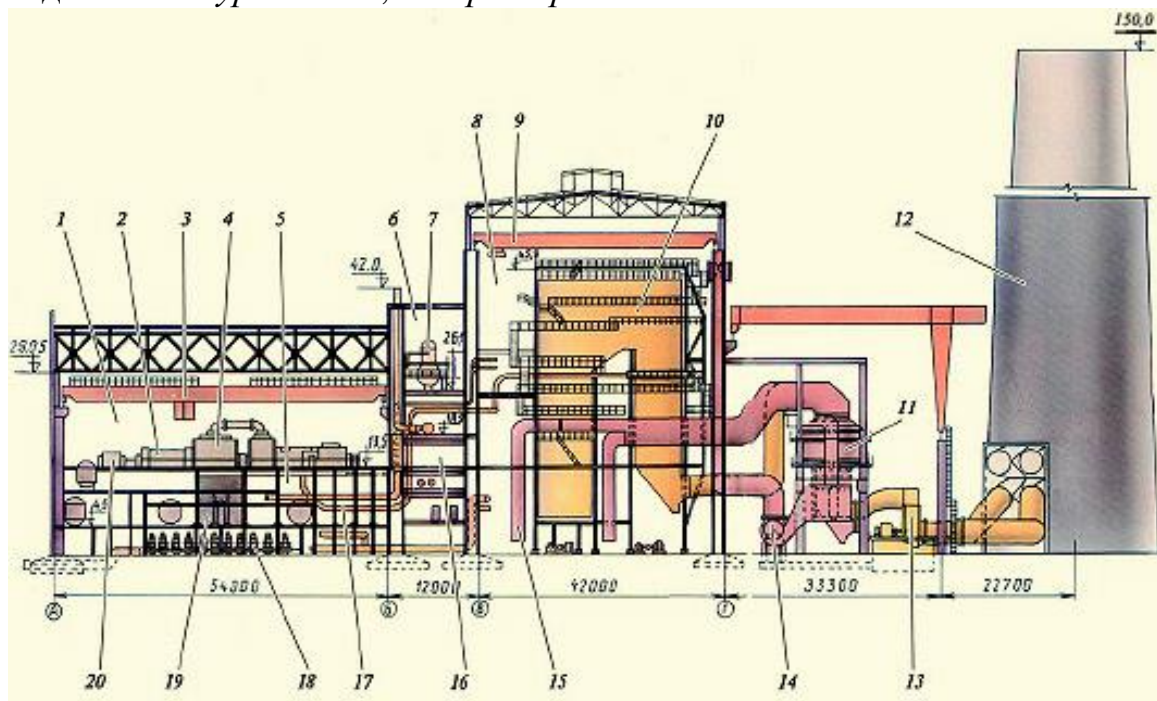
Поперечный разрез главного корпуса ТЭС
